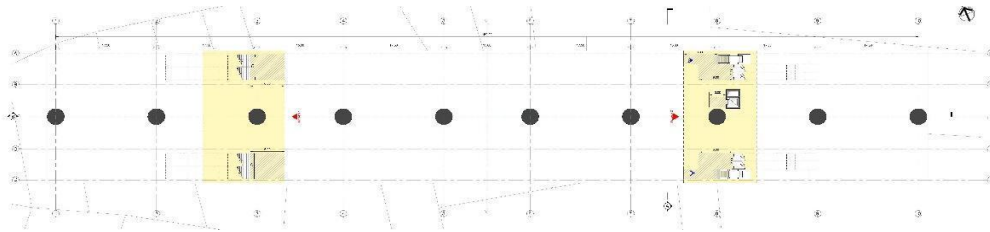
Planta baja de una estación con mezzanine. Fuente: Elaboración propia
